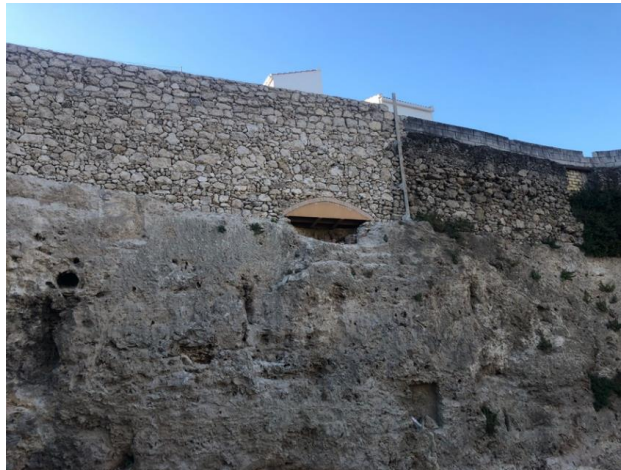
Imagen de la integración de la estructura negativa bajo el muro perimetral reconstruido.
